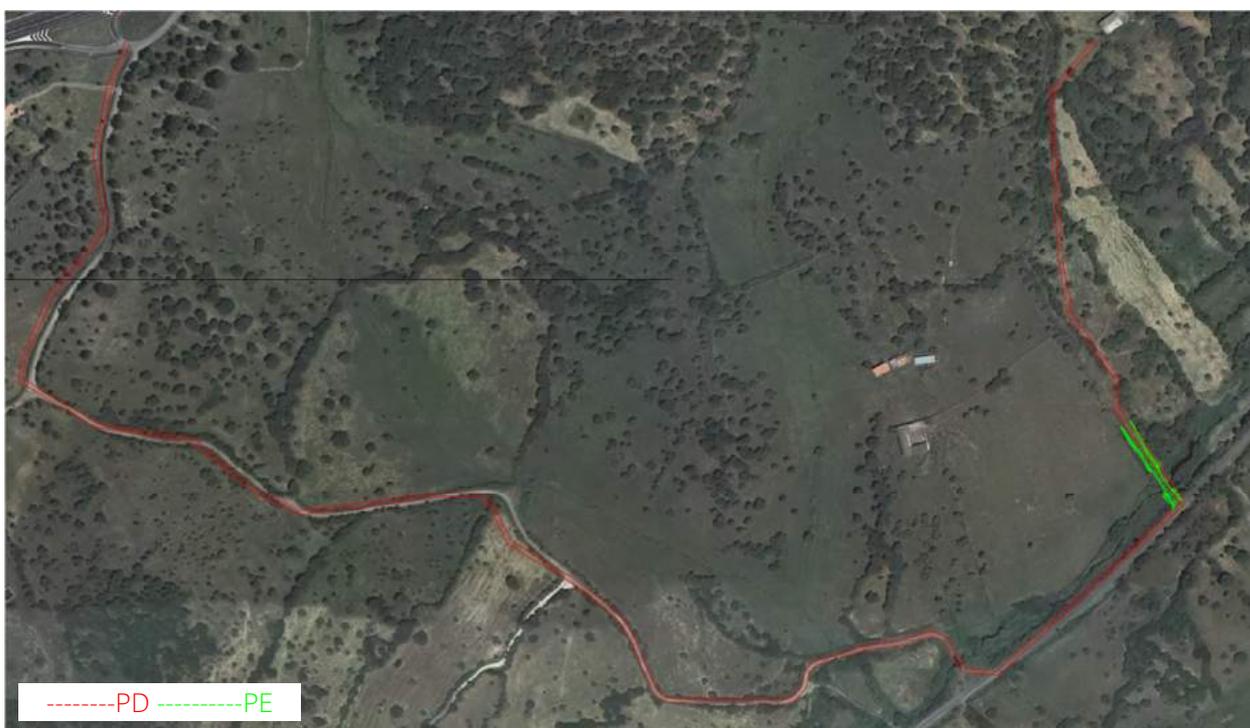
Sovrapposizione PD/PE – S02_Risoluzione accesso CBNAL km 115+205
